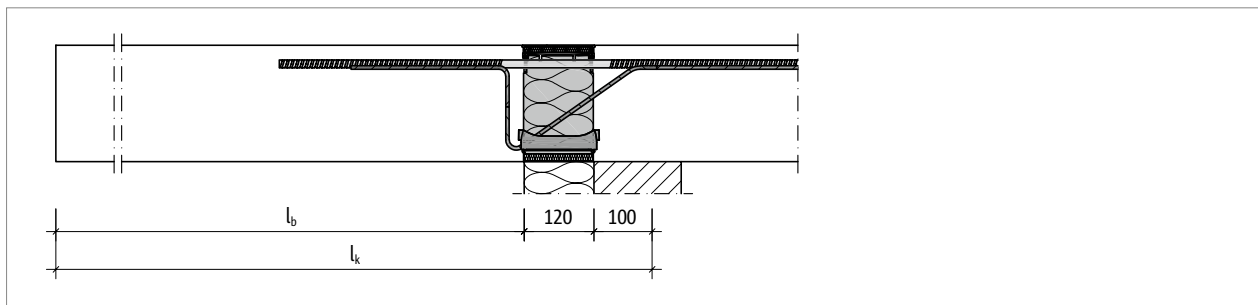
Schöck Isokorb® CXT typ KL-M6-V2: Řez prvkem
